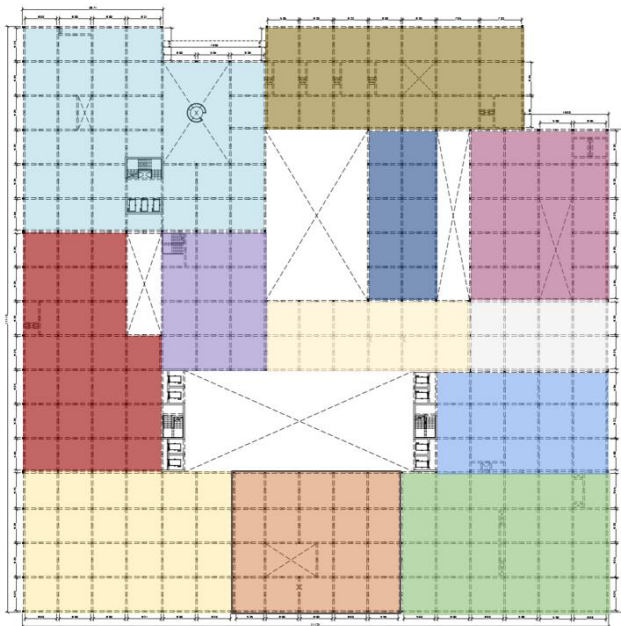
Bloques Estructurales. Fuente: Elaboración Propia
